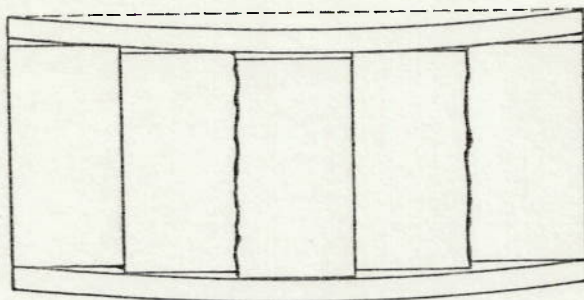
Cisalhamento entre painéis pré-fabricados, provocado pela deflexão dos componentes estruturais
